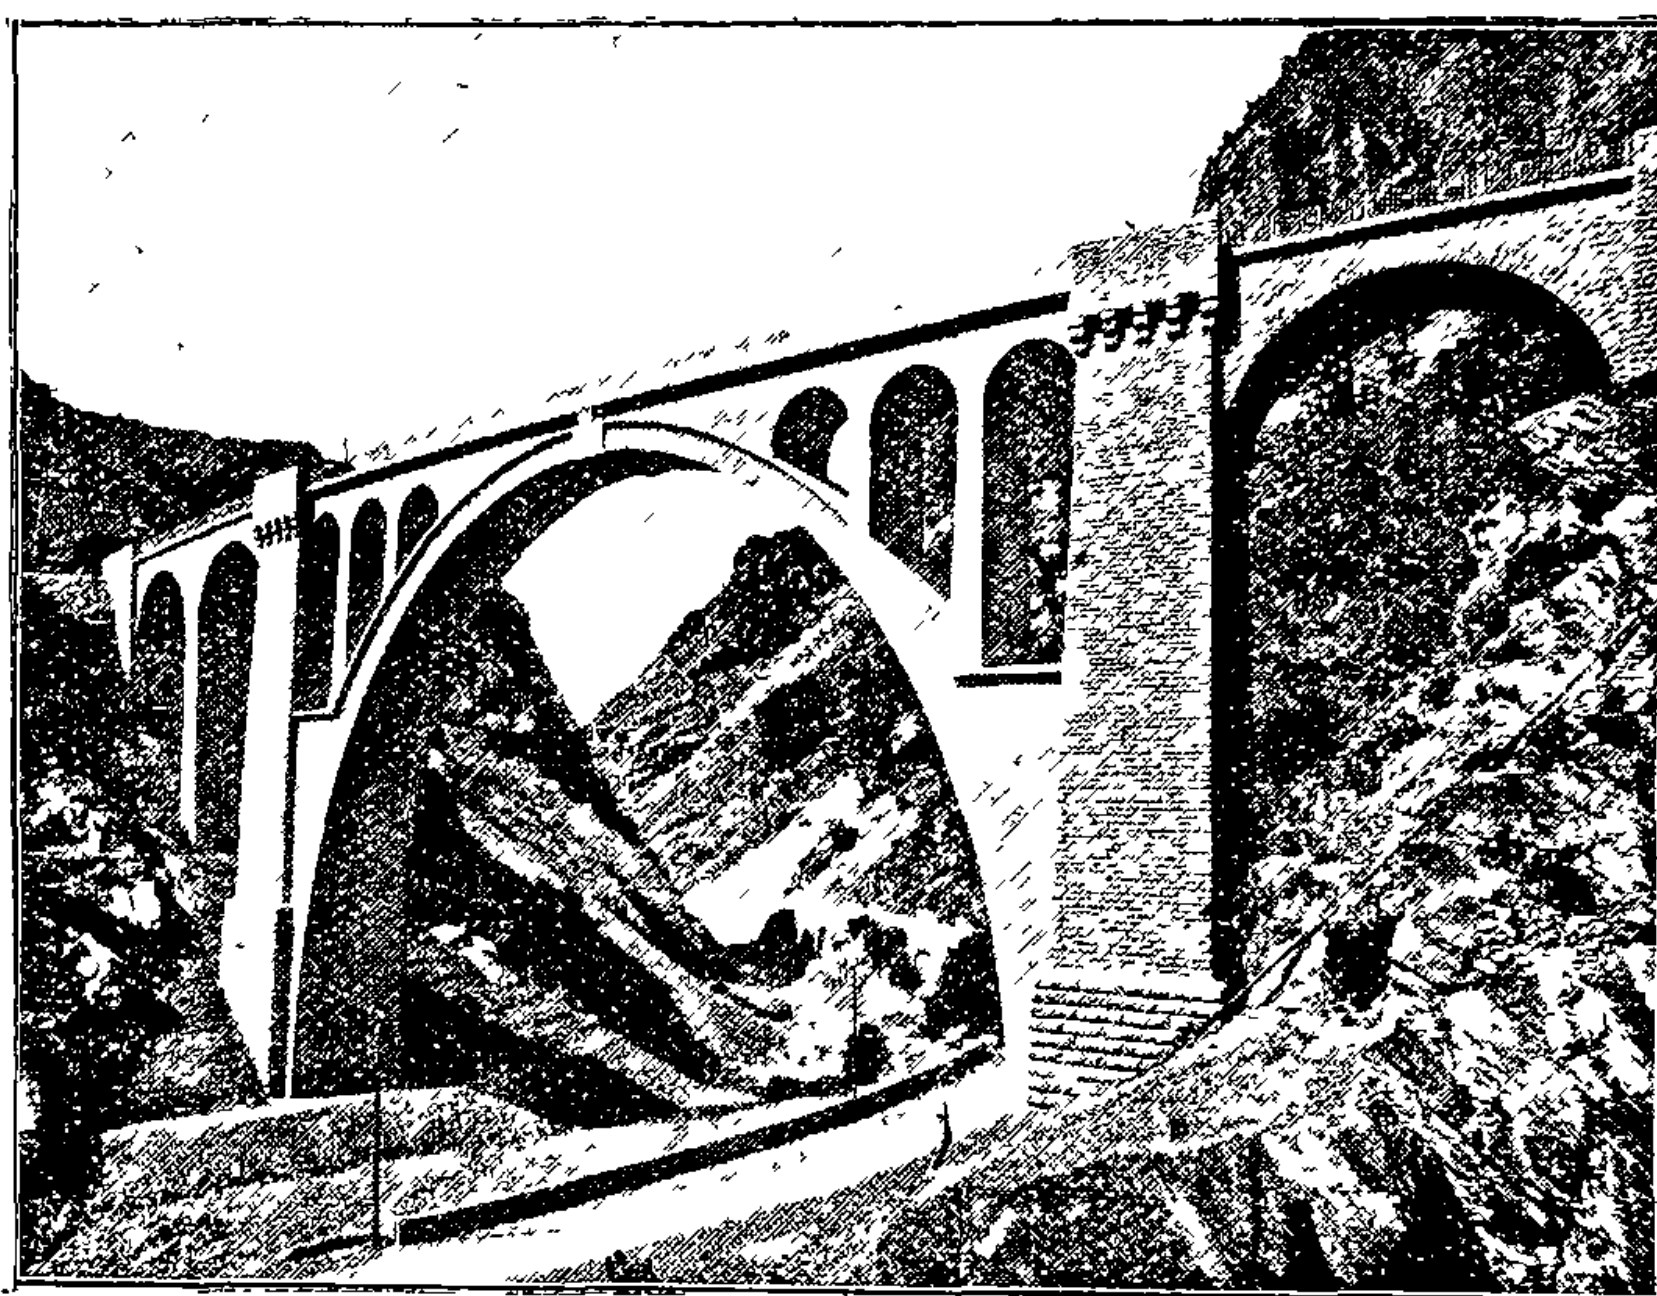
Vue du pont de Scarassoui, sur la Roya.
